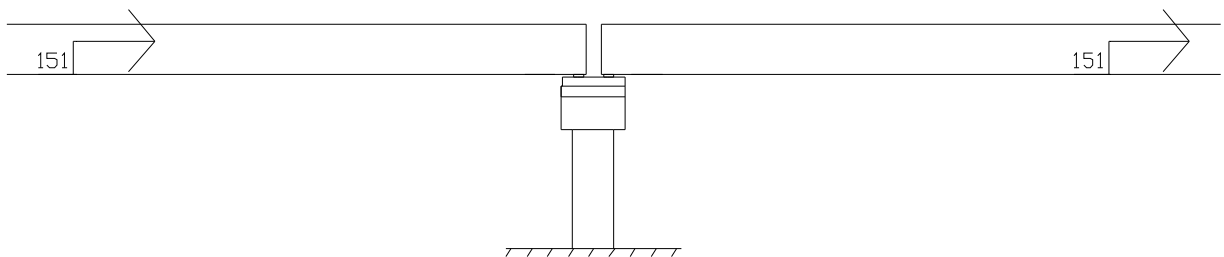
Prospetto longitudinale con applicazione forze orizzontali
